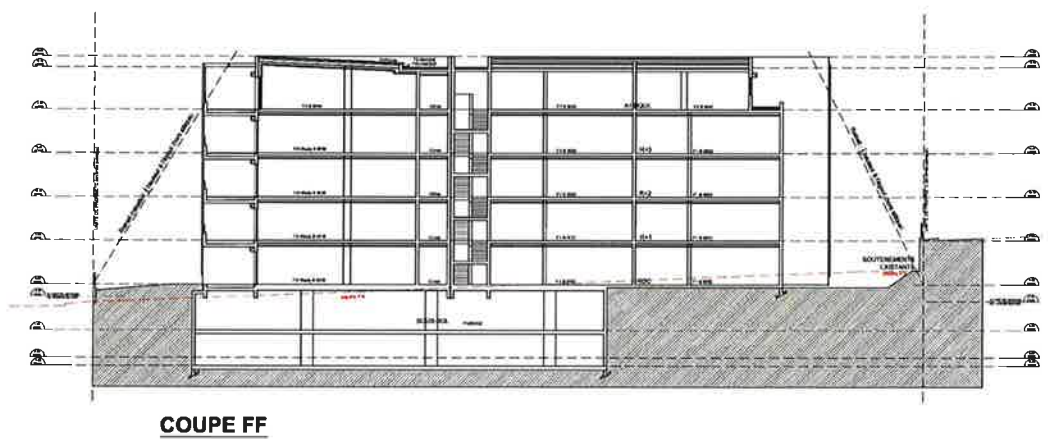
Coupe FF Est-Ouest projet (Plan reçu le 01/12/2020)
